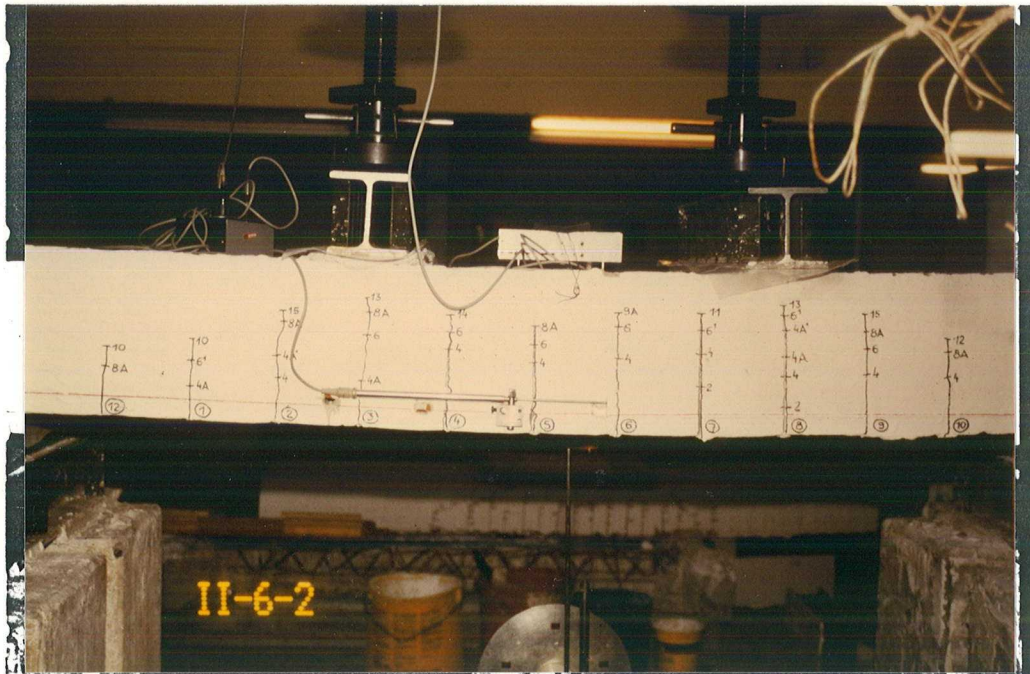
Versuch II/6.2 nach dem Versagen durch Biegebruch
